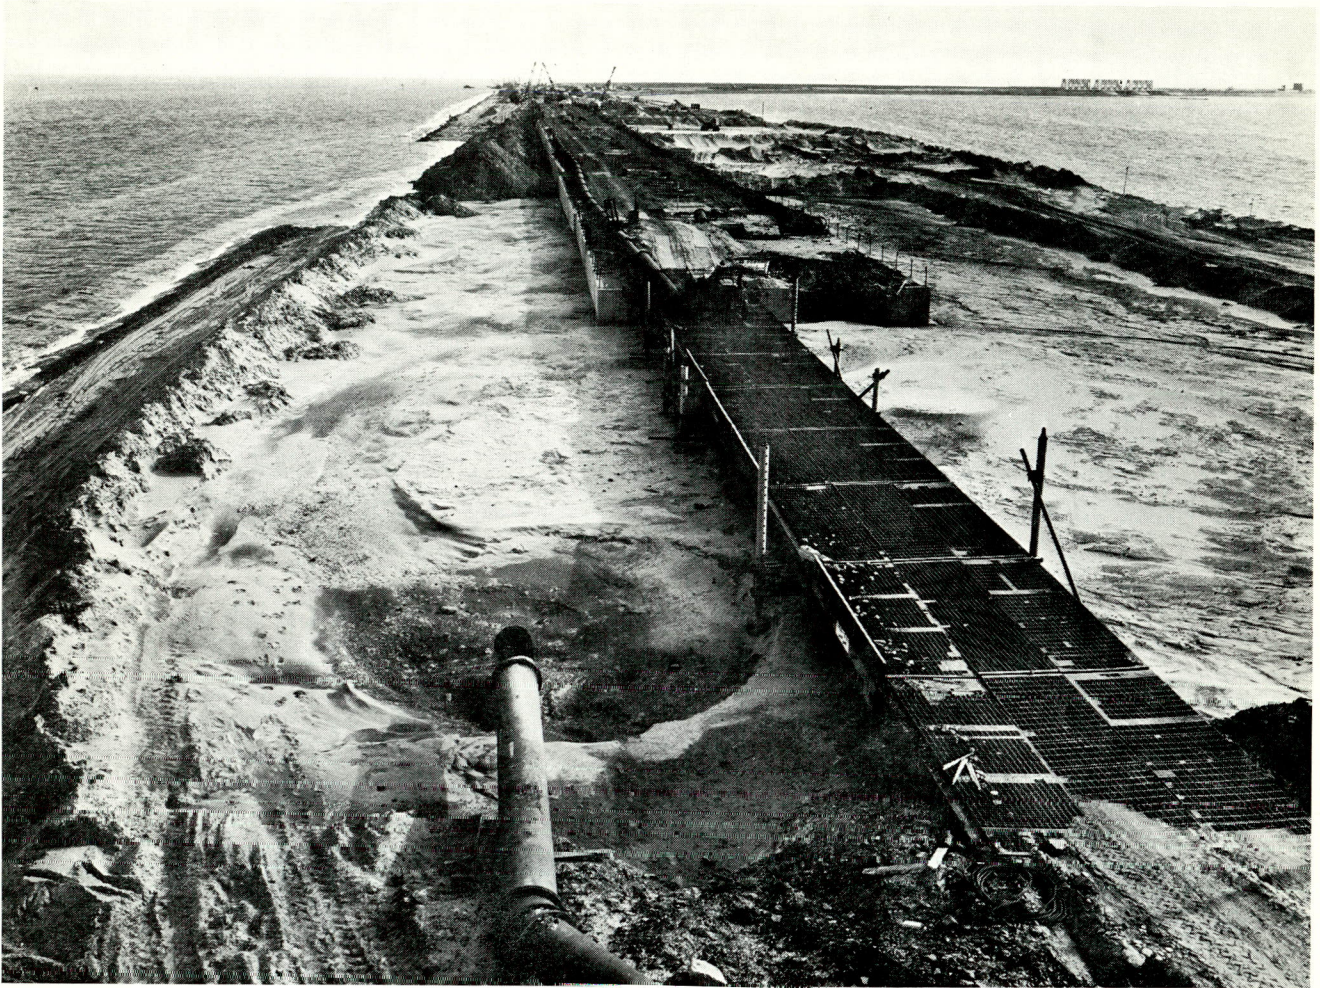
Zandaanvulling ter weerszijden van de caissons
